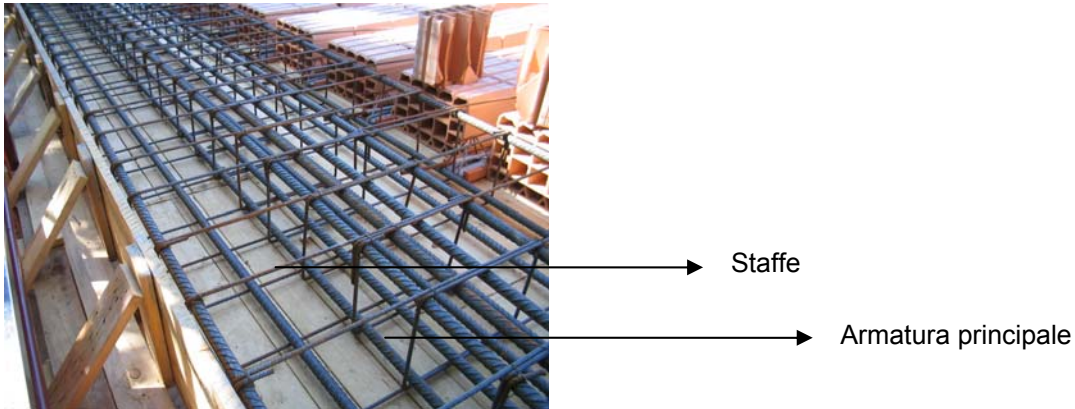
Disposizione tipica delle armature in una trave in c.a.
